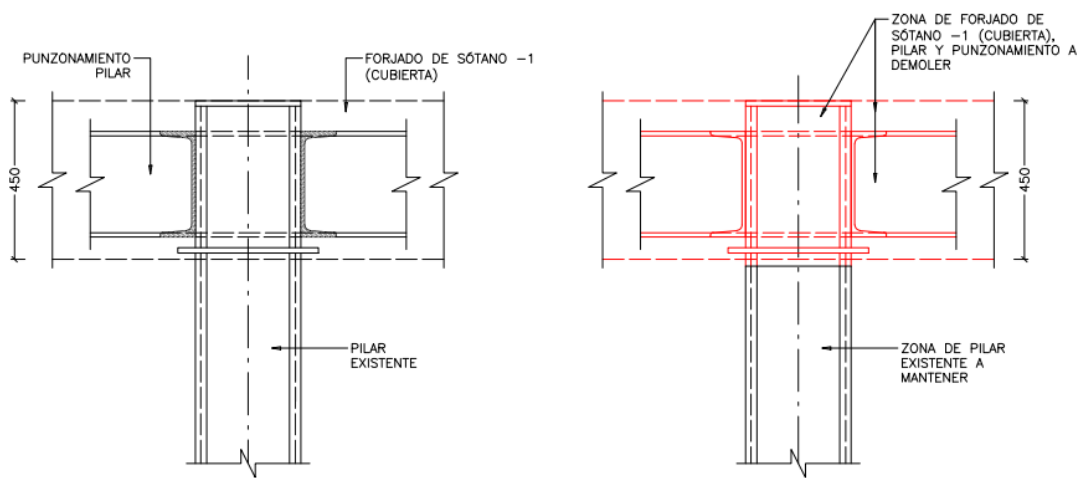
Detalle de demolición y corte de pilares en paños de cubierta a reconstruir.
